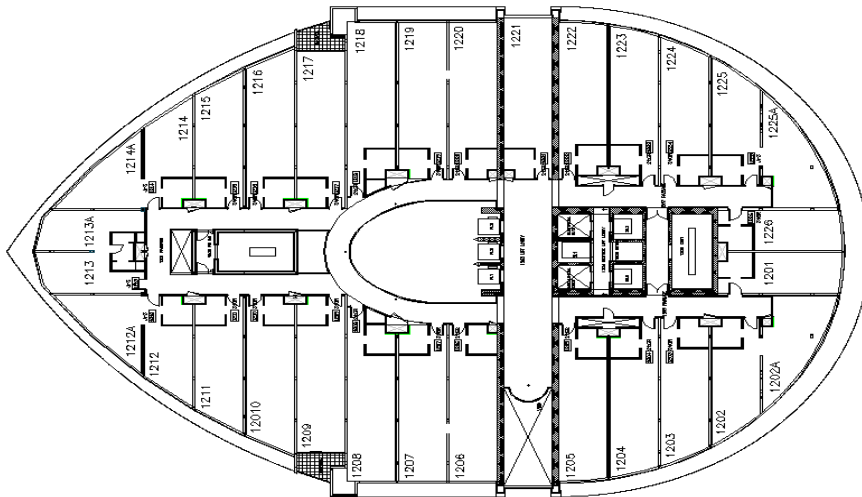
مسقط افقي للطابق الثاني
